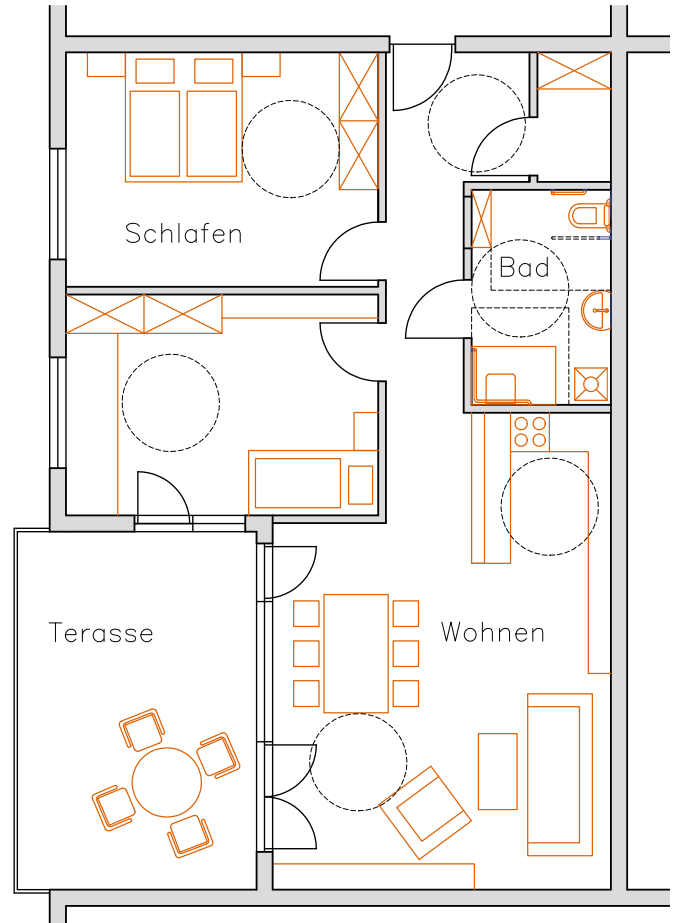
Bild: angepasste 3-Zimmer-Wohnung 87 m²
